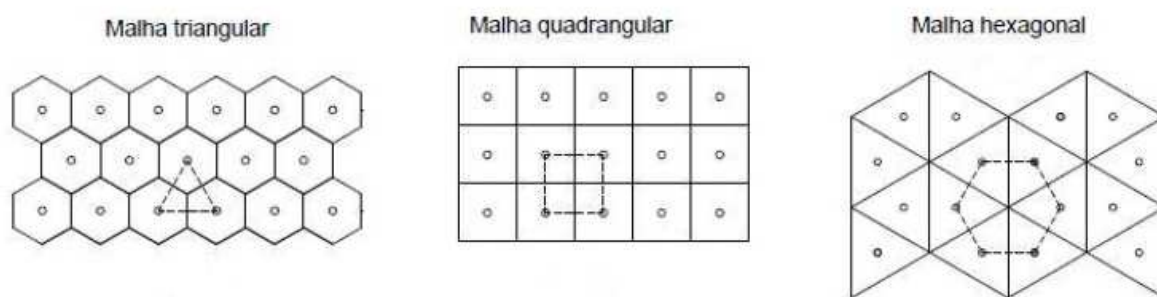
Distribuição em planta de colunas de brita (Assunção, 2010)
